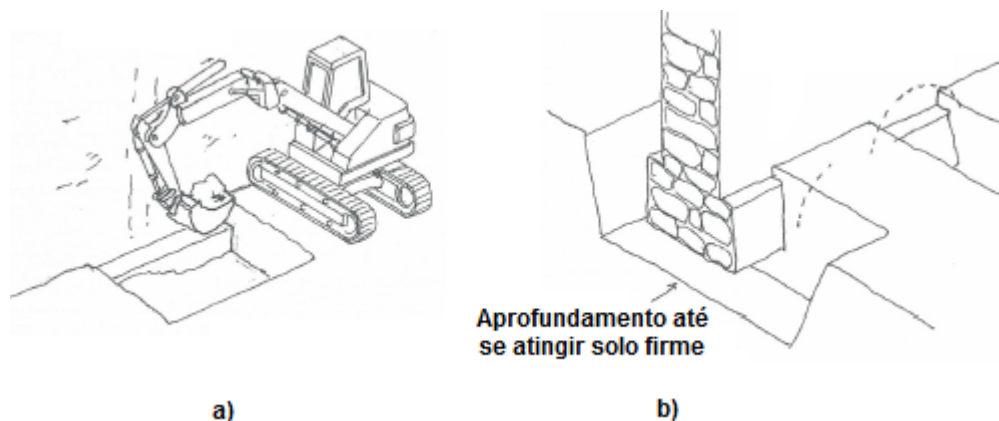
Escavação do terreno por troços alternados: a) equipamento de escavação; b) fundação visível e acessível aos trabalhos [55]
